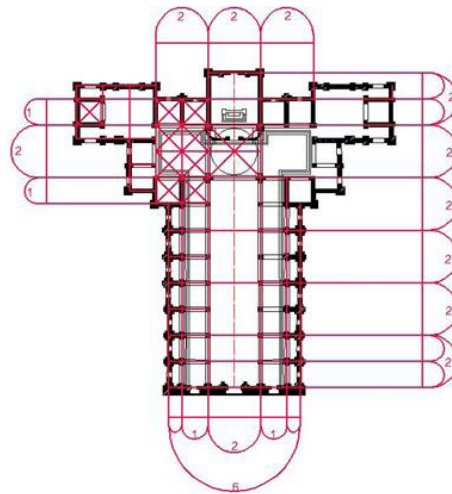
Planta basilical San Lorenzo. Florencia. Brunelleschi
